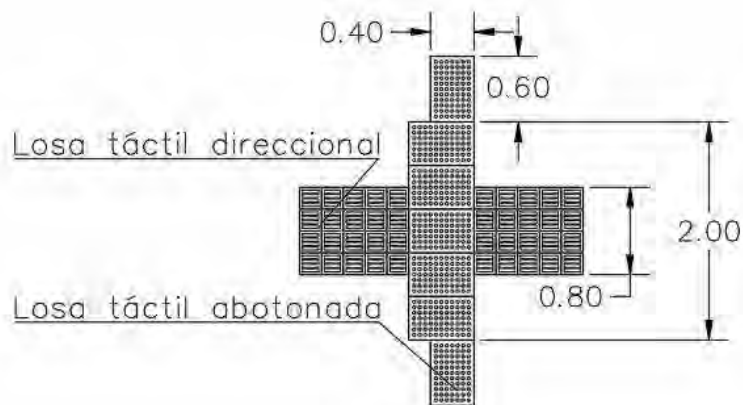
Detalle de la distribución de losas táctiles en cruces sobre la calzada
